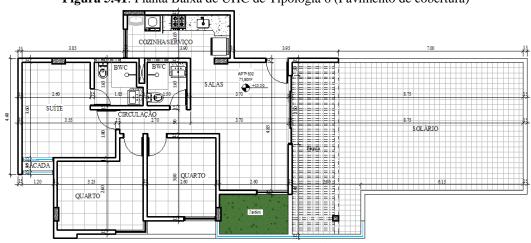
Planta Baixa de UHC de Tipologia 6 (Pavimento de cobertura)
